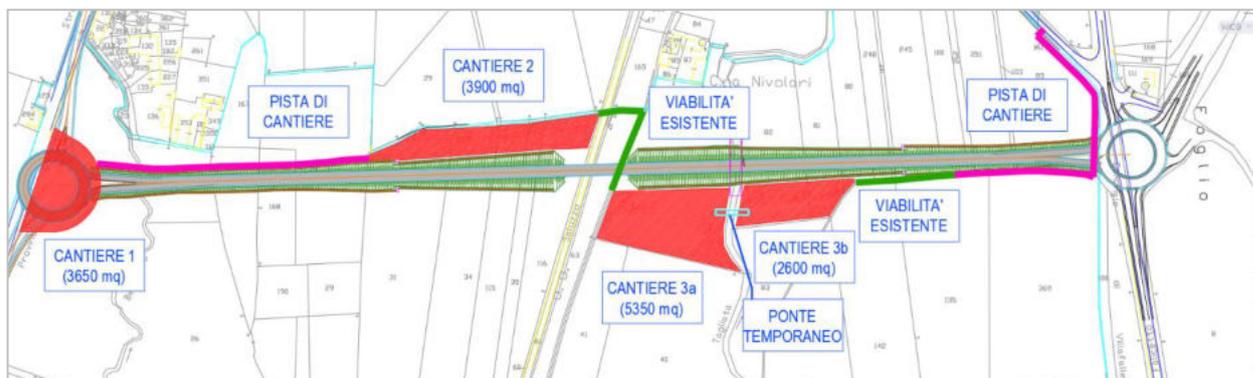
/1 Aree di cantiere e nuovi tratti di pista di cantiere
